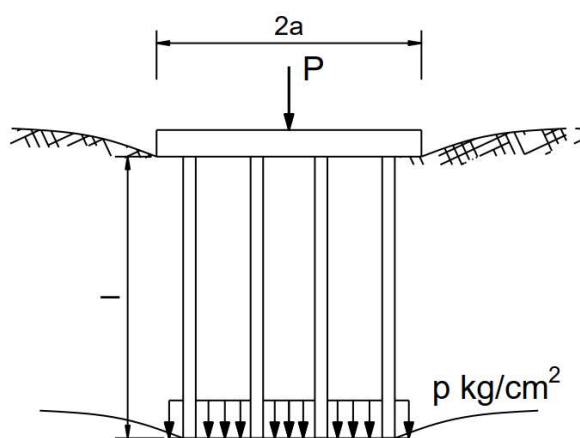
Схема передачи нагрузки, приложенную на кустовые сваи грунту по К.Е. Егорову
